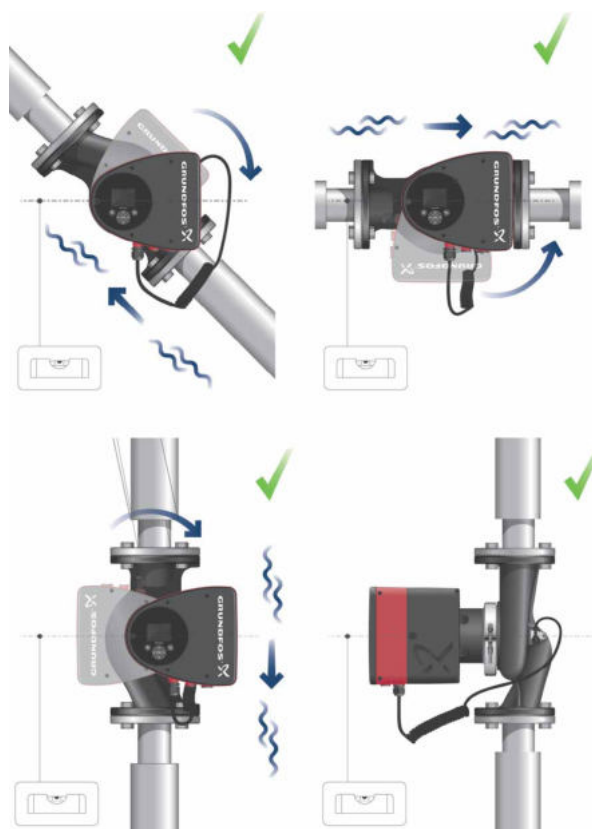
Čerpadlo inštalované hriadeľom motora v horizontálnej polohe
